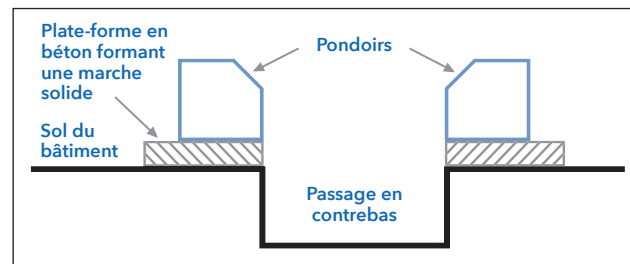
Exemple d'un système de pondoirs avec un passage en contrebas
